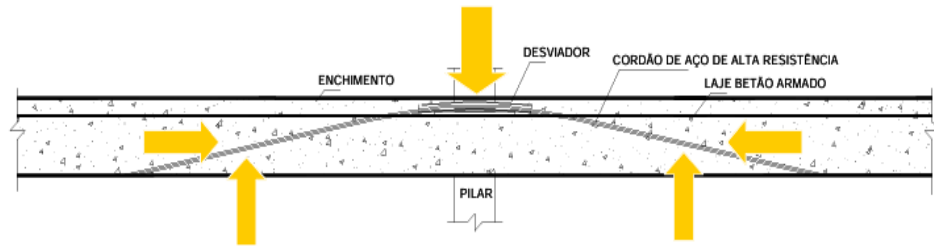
Reforço de laje fungiforme em zona de ligação laje-pilar, com aplicação de pré-esforço (21).
